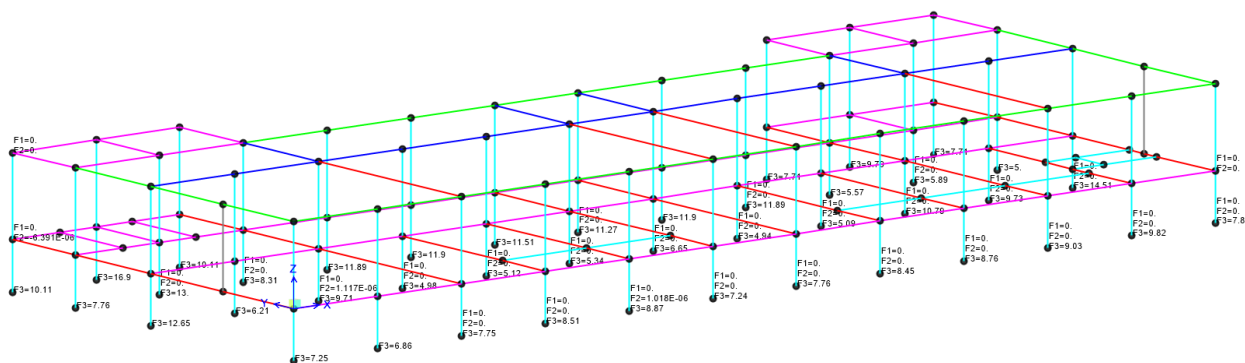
ESTRUCTURA DE HORMIGÓN | VIGAS DE FUNDACIÓN
